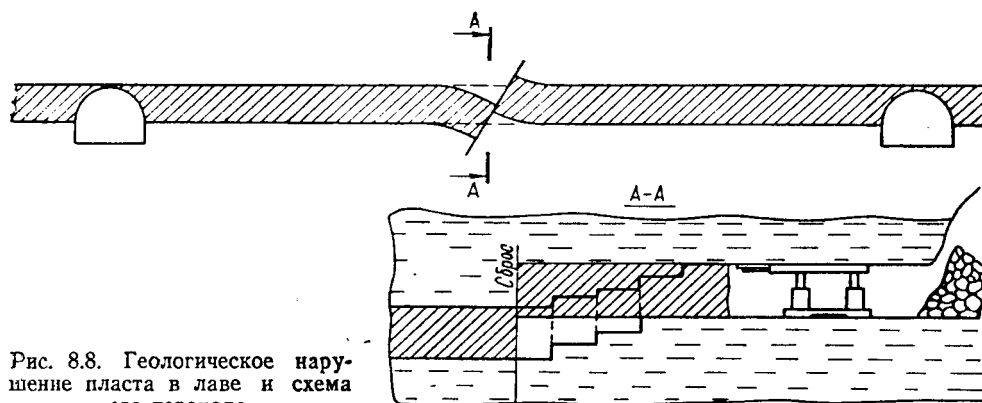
Геологическое нарушение пласта в лаве и схема его перехода.
